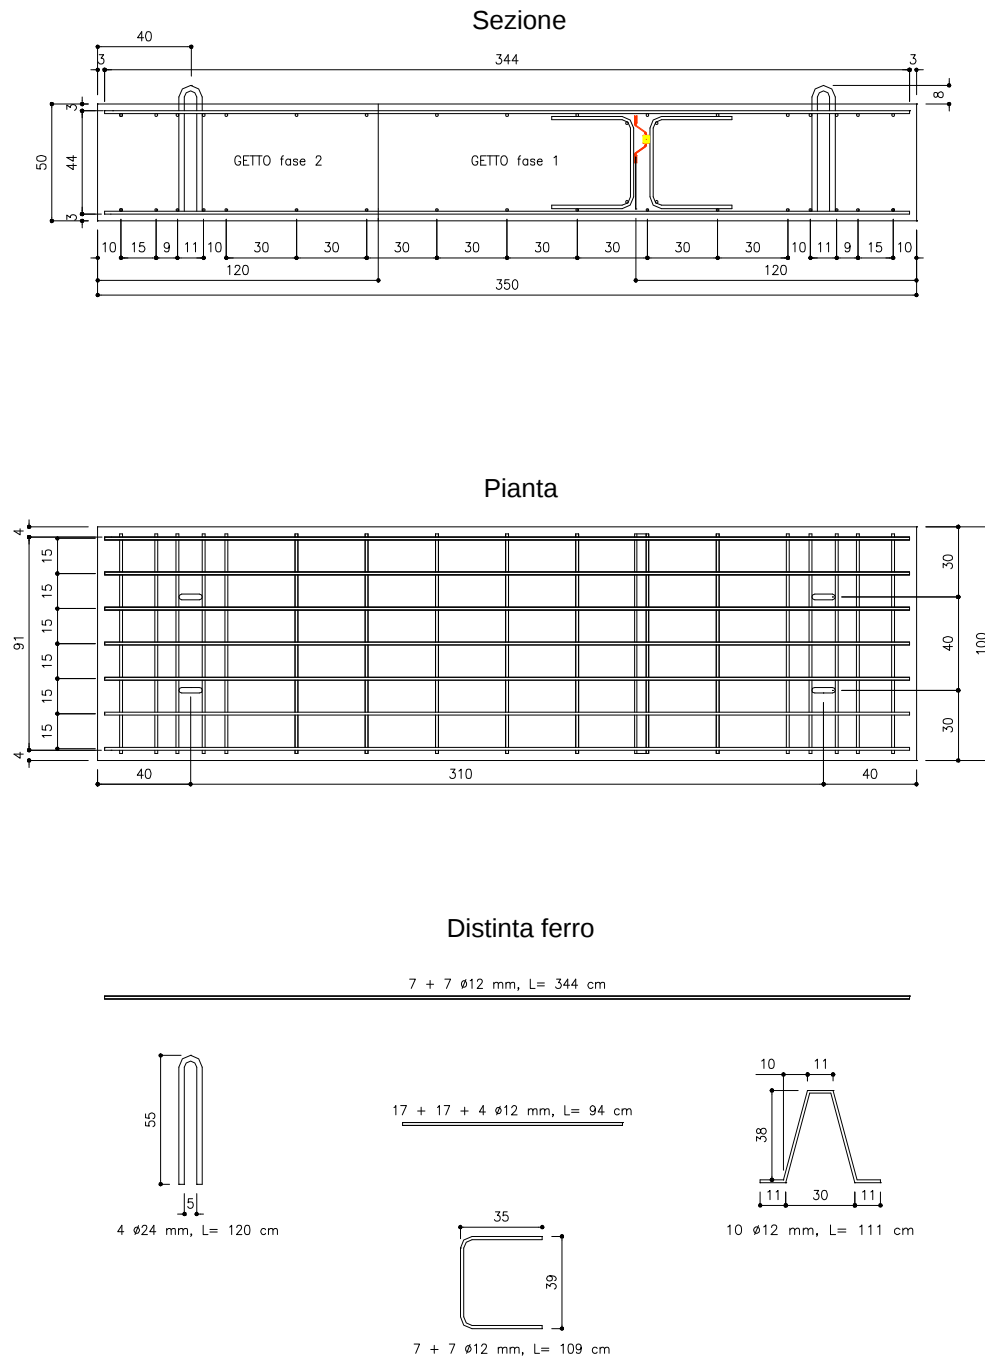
Trave DRY 4: trave con giunto “Drytech” con orientamento destro e ripresa di getto.
